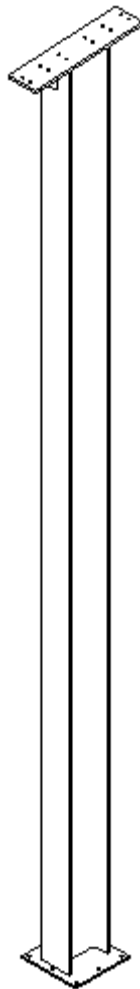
Pilar metàl·lic perfil HEB450 pels pilars centrals de la primera i última fila. (Font: "Revit")
